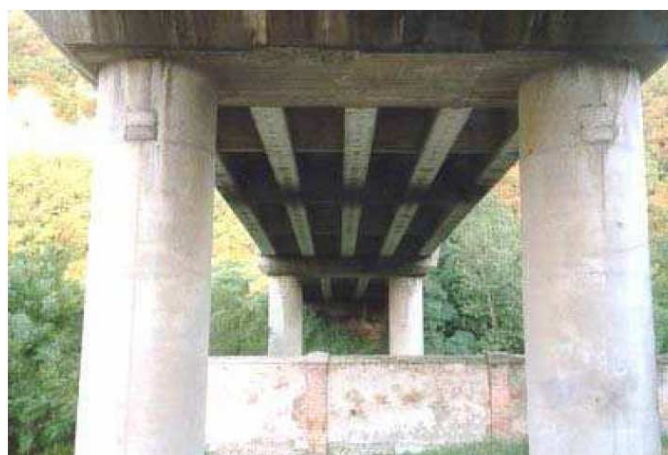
Viste della struttura a telaio delle pile del ponte di Fener, Alano di Piave (TV)
